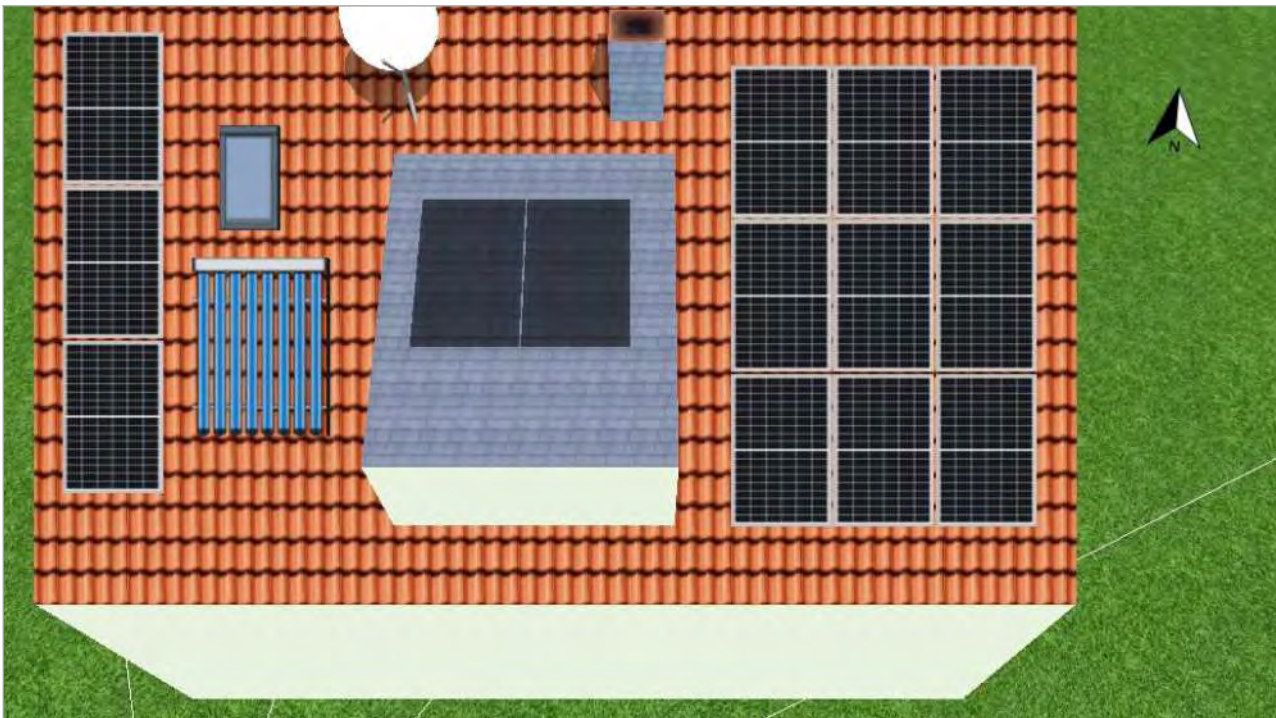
Modulfläche - Gebäude 01-Dachfläche Süd
